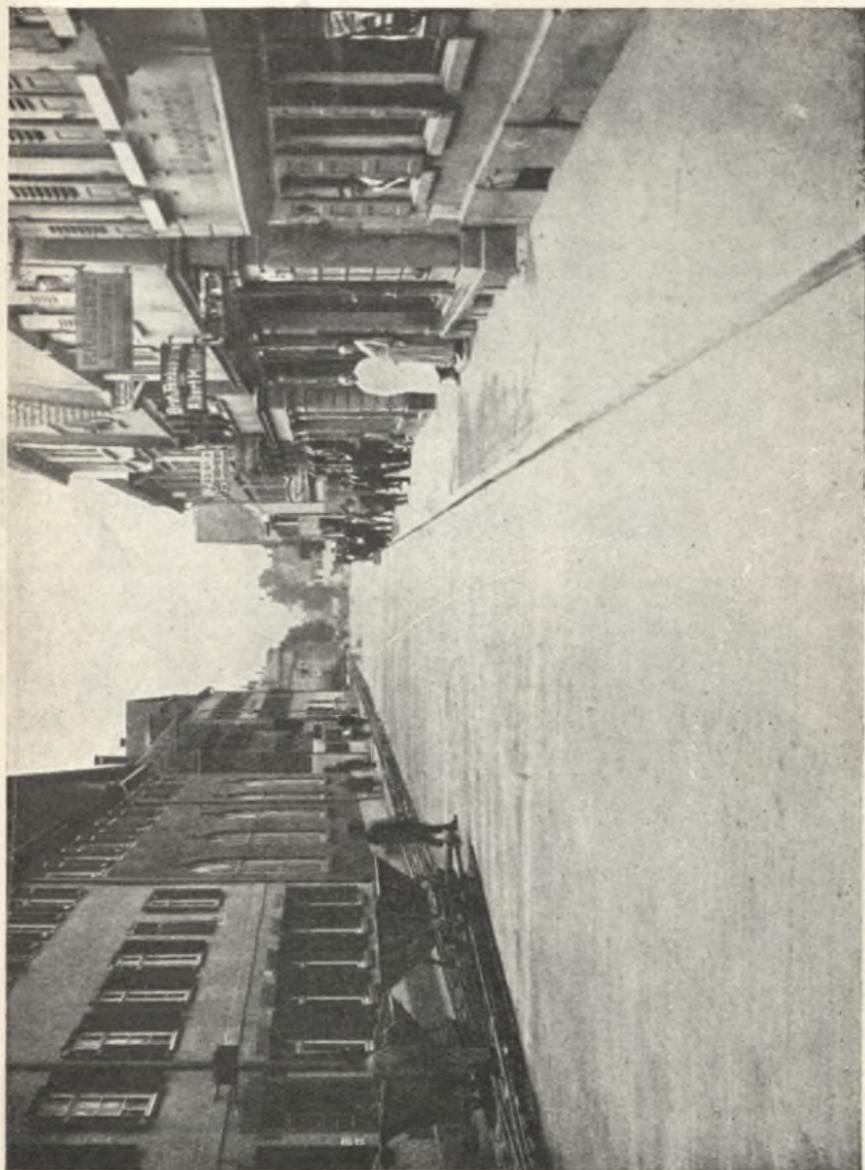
Stuttgarter Straße zu Göppingen, Soliditit-Beton.
